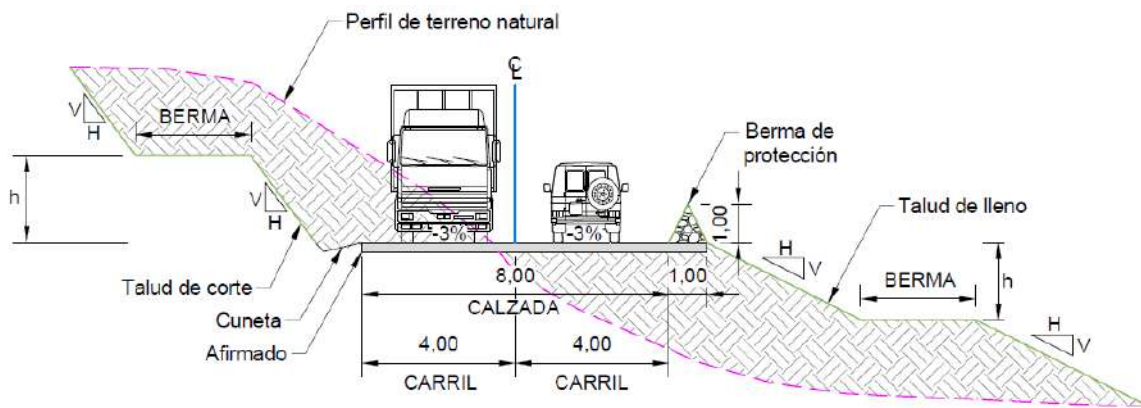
Sección típica vía para operación – Ancho 8,0 m
